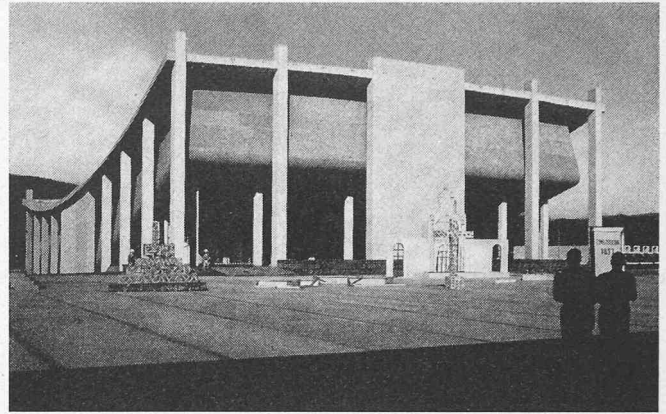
Auditorium Jalapa, Mexiko. In sich verspanntes Hängedach mit 71 m Spannweite über einer Grundfläche von 40×71 m
